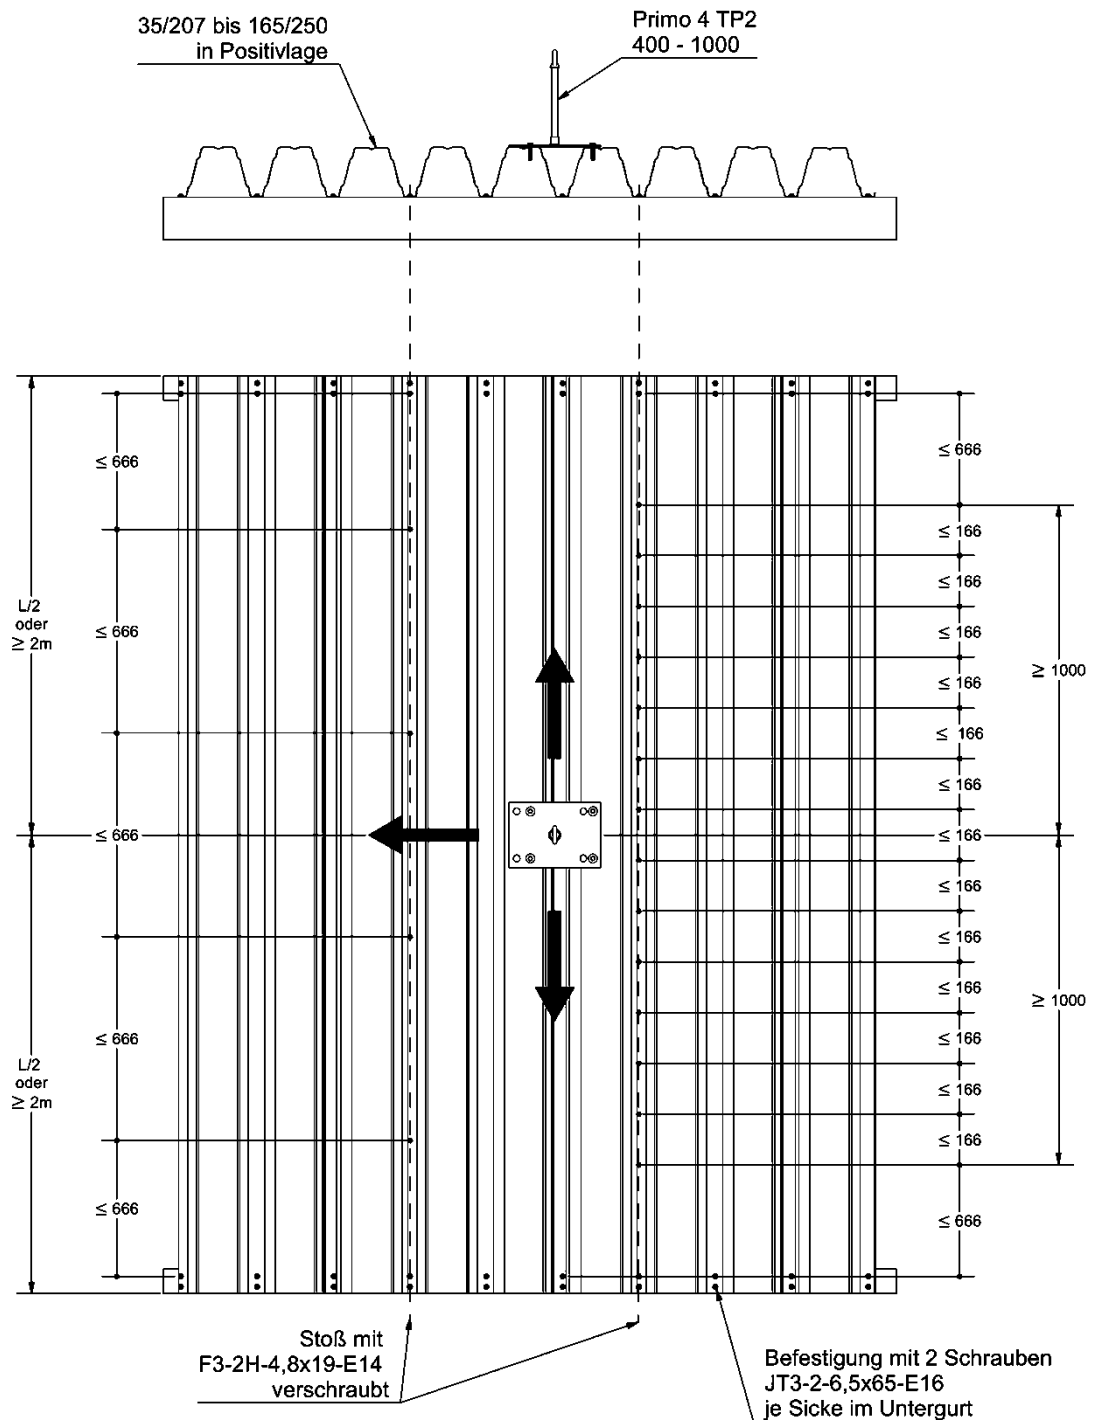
Primo 4 TP2, Variante B-2: Positivlage, Befestigung im anliegenden Gurt (siehe Zeichnung mit 1 oder 2 Schrauben), Profilhöhen 35 bis 165mm, Blechdicke 0,75mm
